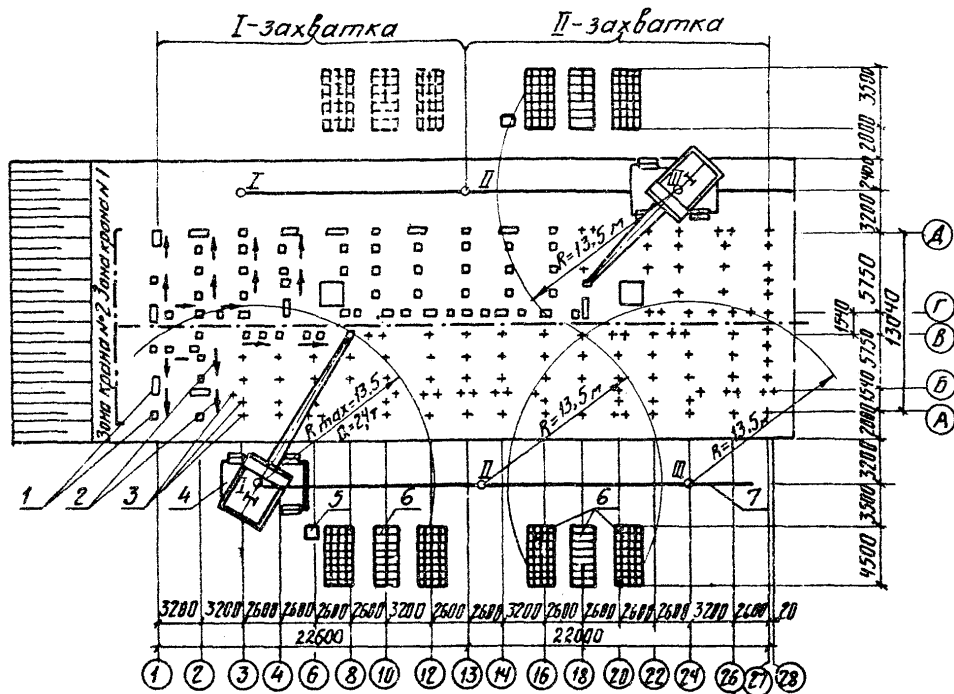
Схема организации работ по монтажу оголовков: I-смонтированные оголовки; 2-направление монтажа; 3-забитые сваи; 4-пневмоколесный кран К-161; 5-лук для приема бетона; 6-штабеля оголовков; 7-ось движения крана; I, II, III - стоянки крана
